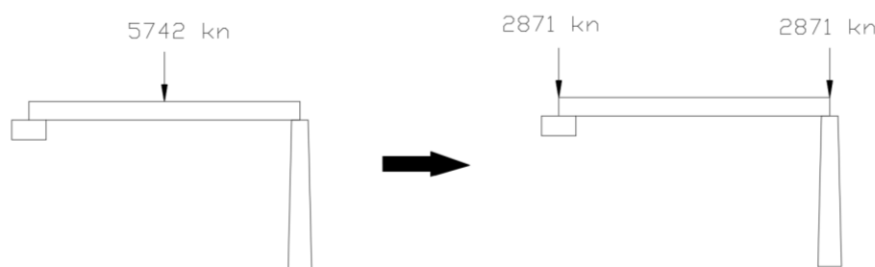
Cargas puntuales en Estribo 1 y Pila 1
